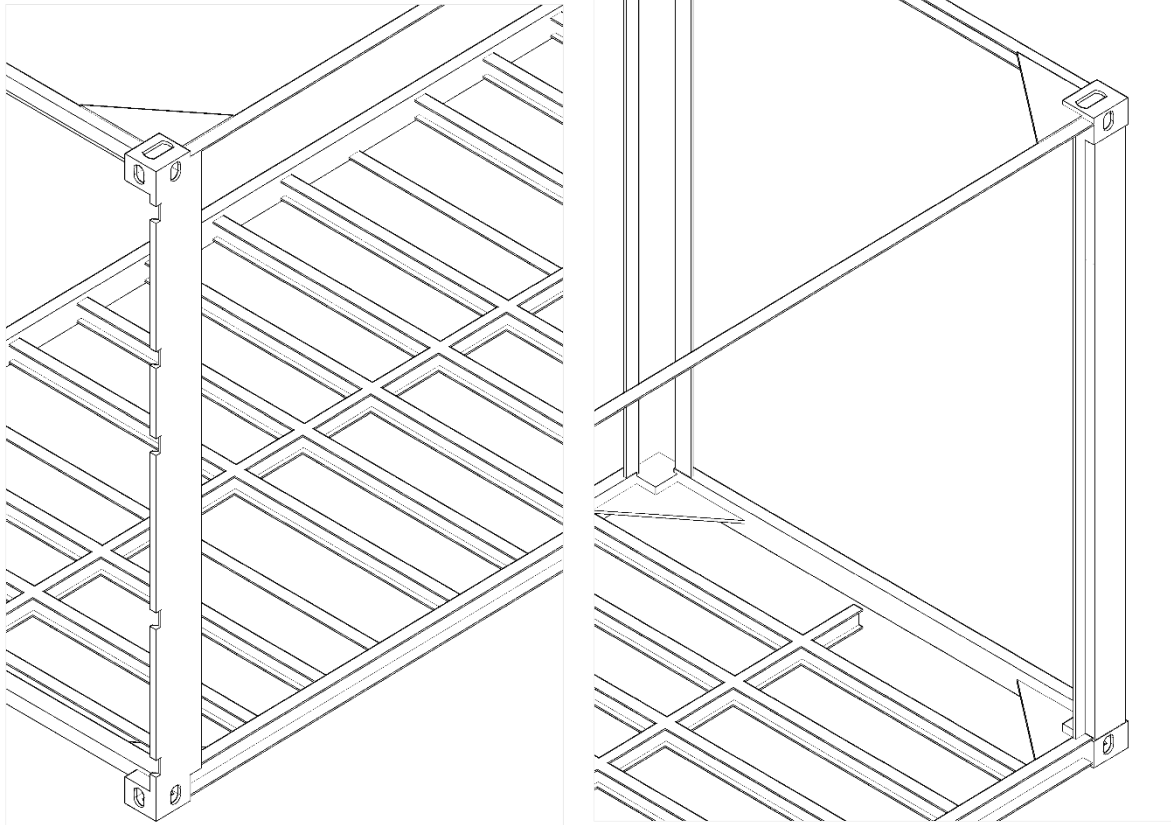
Isometrías en detalle de las uniones estructurales del contenedor, de los pilares con el suelo y la cubierta. Elaboración propia.
